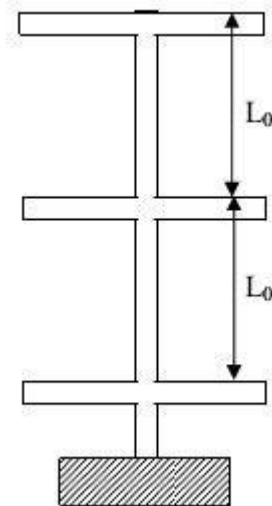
Longueur de flambement d'un poteau de bâtiments à étages multiples
